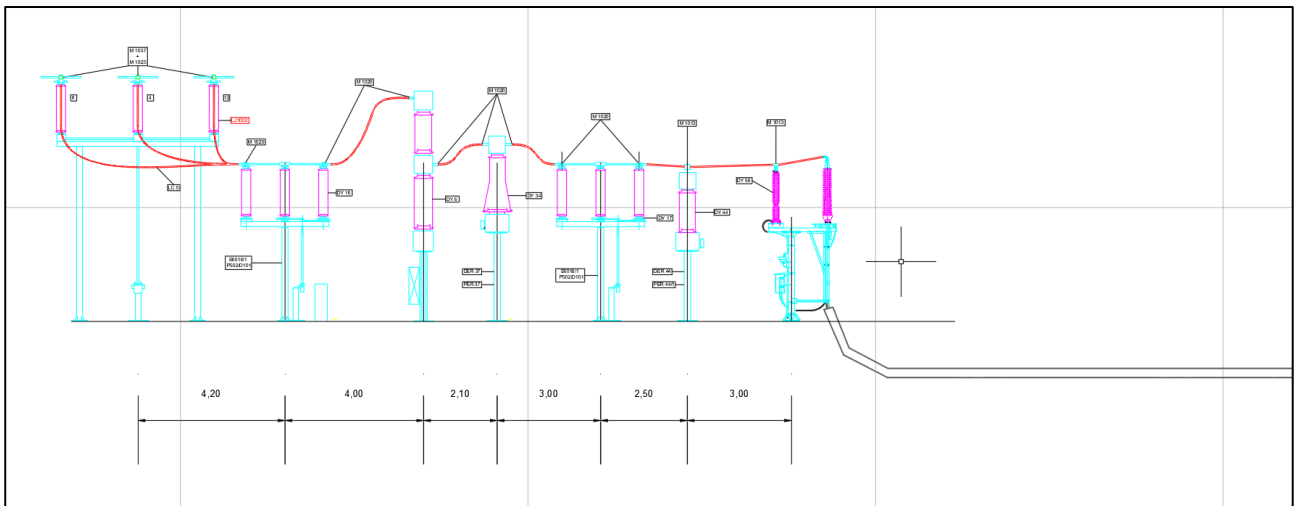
sezione nuovo Stallo Arrivo Produttore (Impianto di Rete per la Connessione) da realizzare presso la CP Altedo
